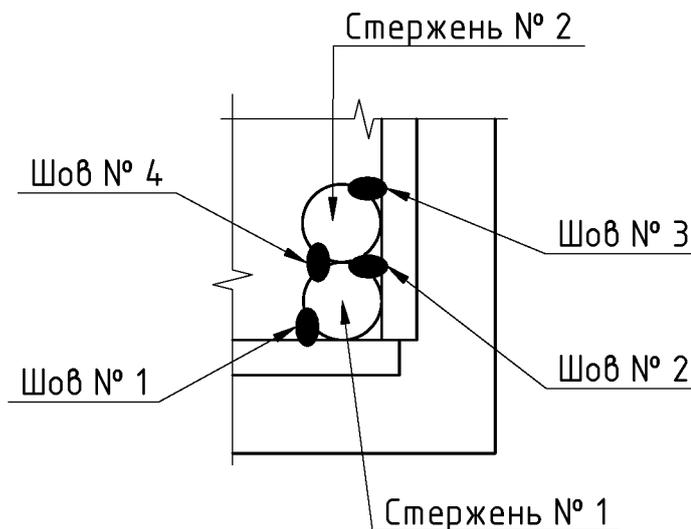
Схема приварки арматурных стержней к закладным деталям М6
